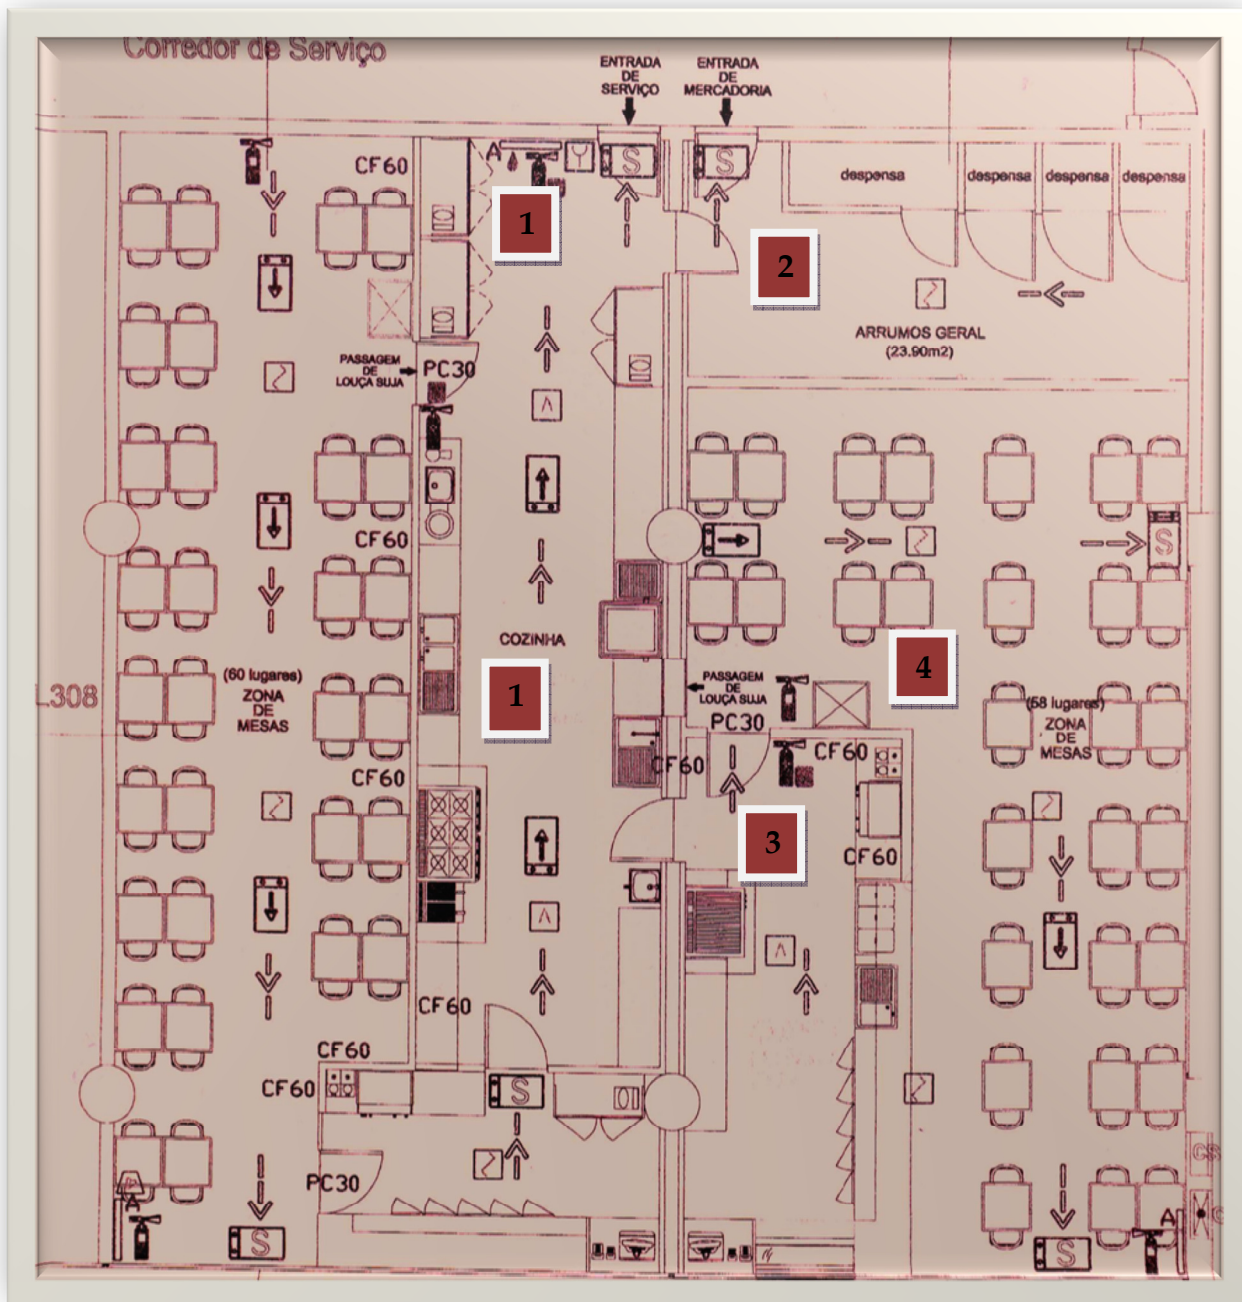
Layout do Estabelecimento de Restauração da Empresa B
